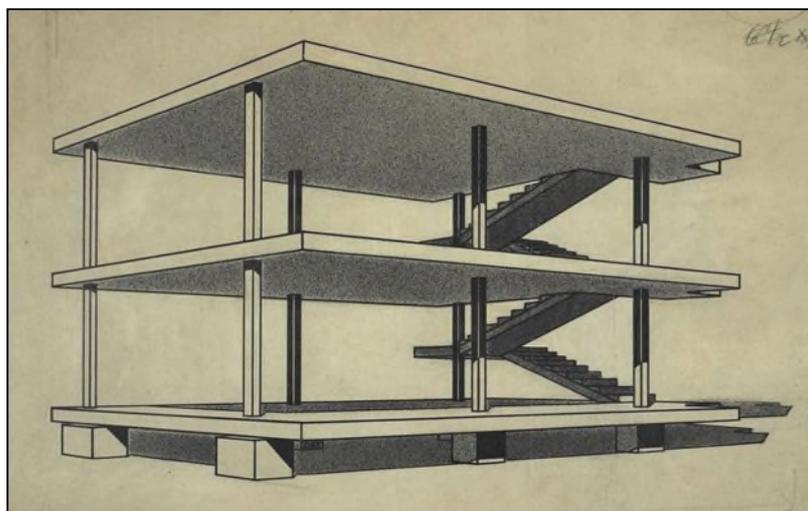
Structure de la maison Dominière, *source : fondationlecorbusier.fr
